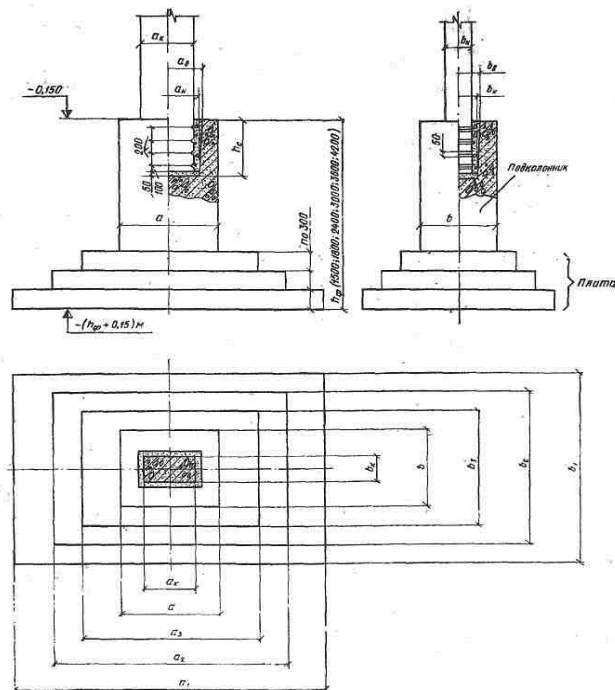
Збірний залізобетонний фундамент [6].
